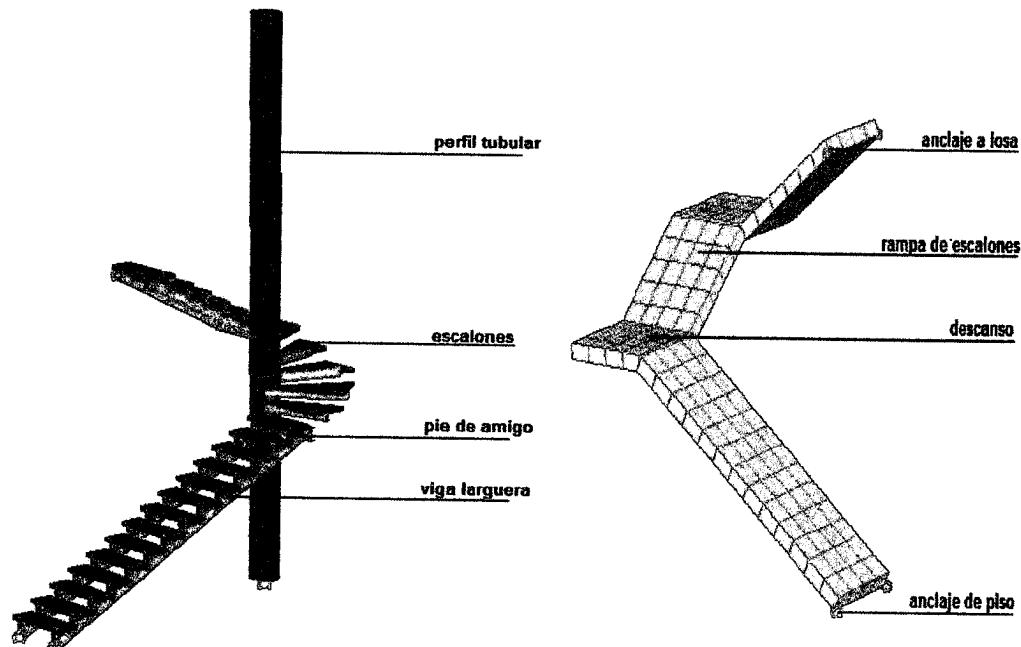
, Detalle modelado de escalera metálica tipo caracol y de concreto armado.
